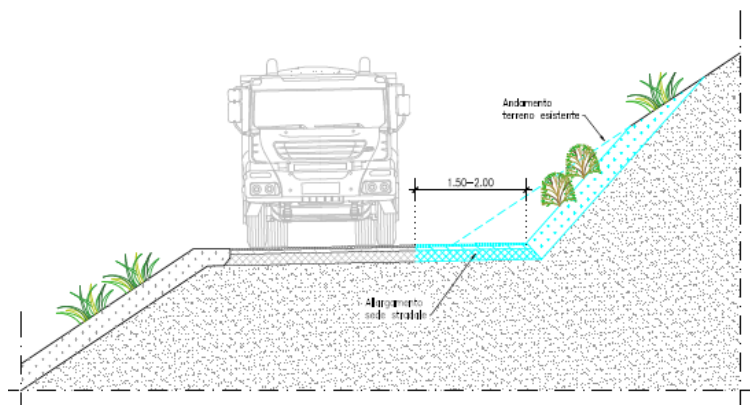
Sezione tipo sistemazione minimale viabilità accesso alla cava Damos.
